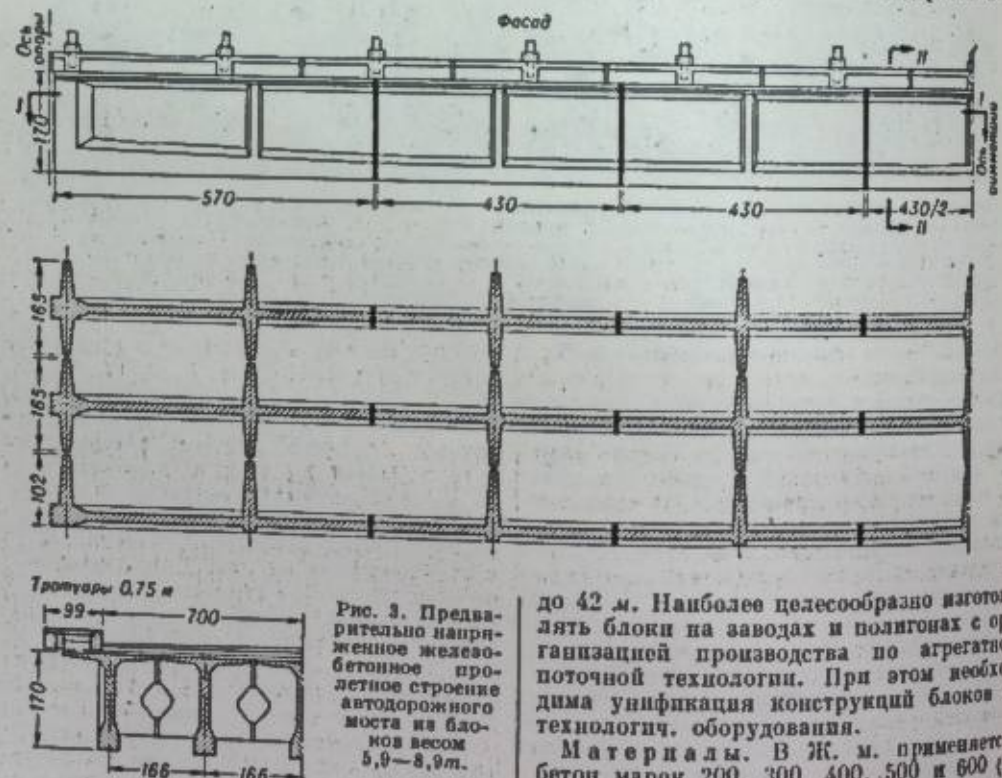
Предварительно напряженное железобетонное пролетное строение автодорожного моста из блоков весом 5,9—8,9 т.
